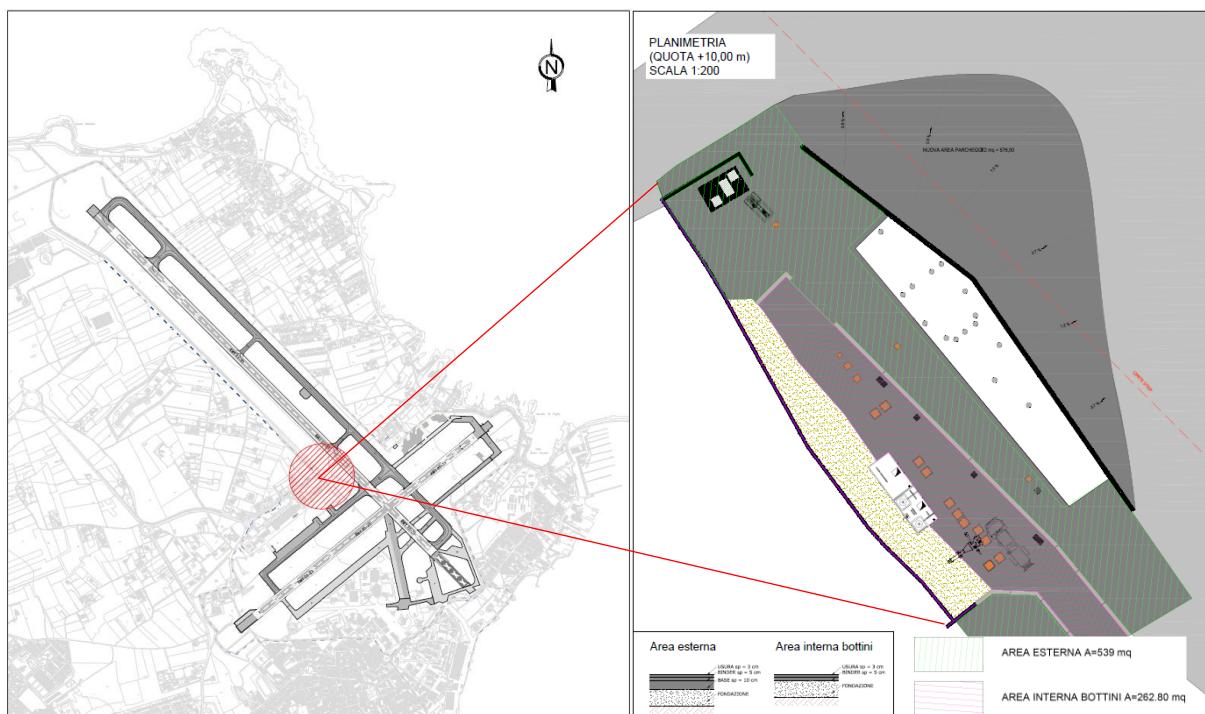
Localizzazione e planimetria impianto trattamento bottini di bordo.
